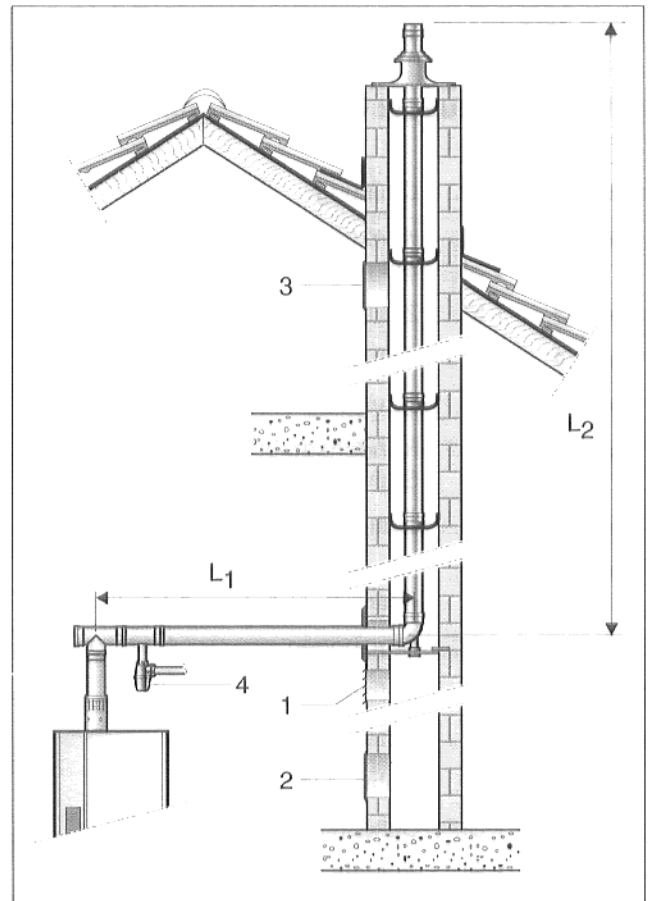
Grundbausatz GA, Abgasführung mit Aluminium-Rohren
